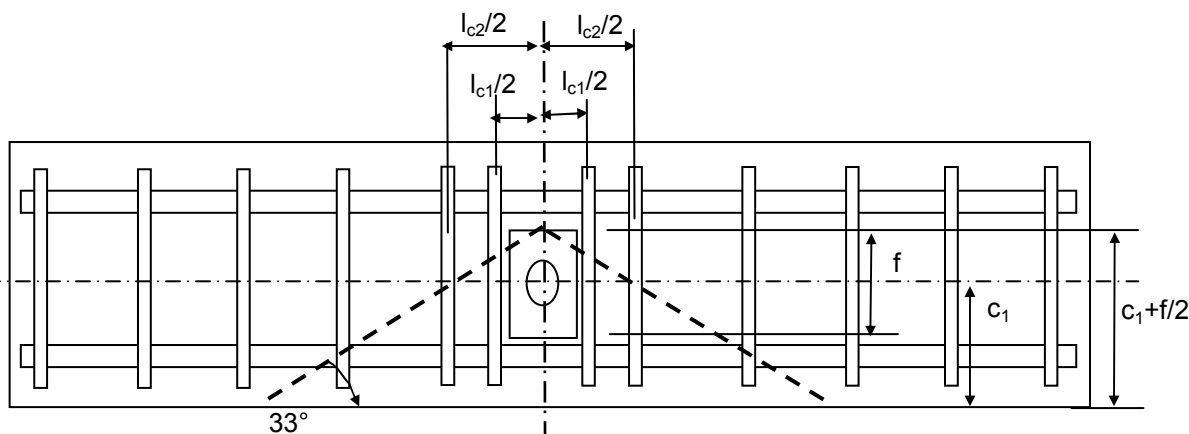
Darstellung des Bruchkegels für Betonkantenbruch bei den Schubdornen der Serie CRET 100
